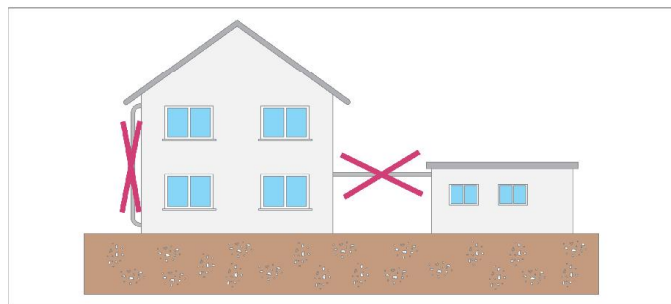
Наружная прокладка трубопроводов RAUTITAN flex, например, трубопроводов водоснабжения без соответствующих защитных мер недопустима
